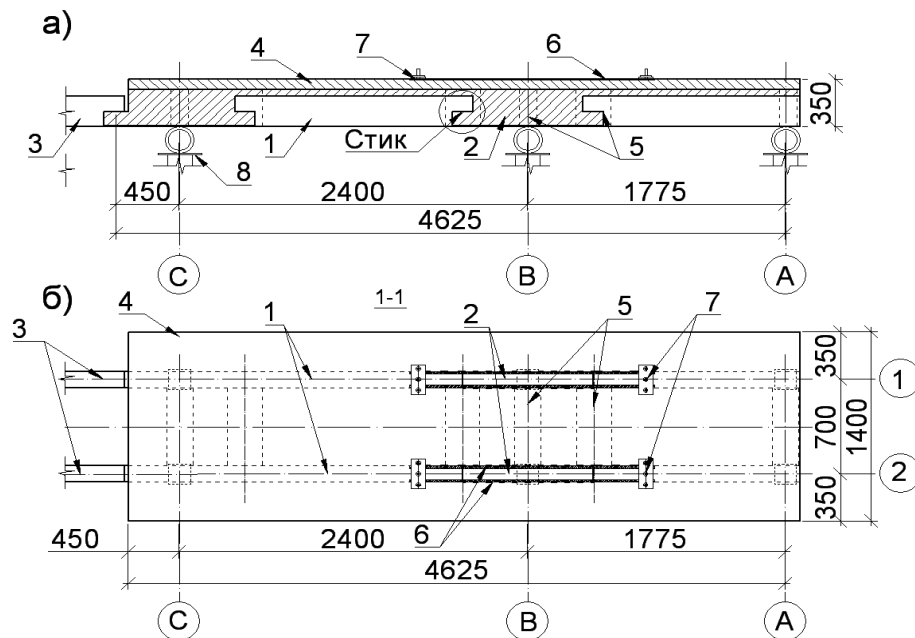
Прямолінійна нерозрізна частина дослідної конструкції двобалкової прогонової будови мосту із збірно-монолітного залізобетону: 1 – збірні прогонові балки, 2 – надпорні монолітні балки, 3 – вільно оперта збірна балка на консолі нерозрізної конструкції, 4 – монолітна частина балок і плита, 5 – поперечні балки, 6 – надпорна неметалева стрічкова арматура, 7 – анкер стрічкової арматури, 8 – опора стенду із кільцевим динамометром.
